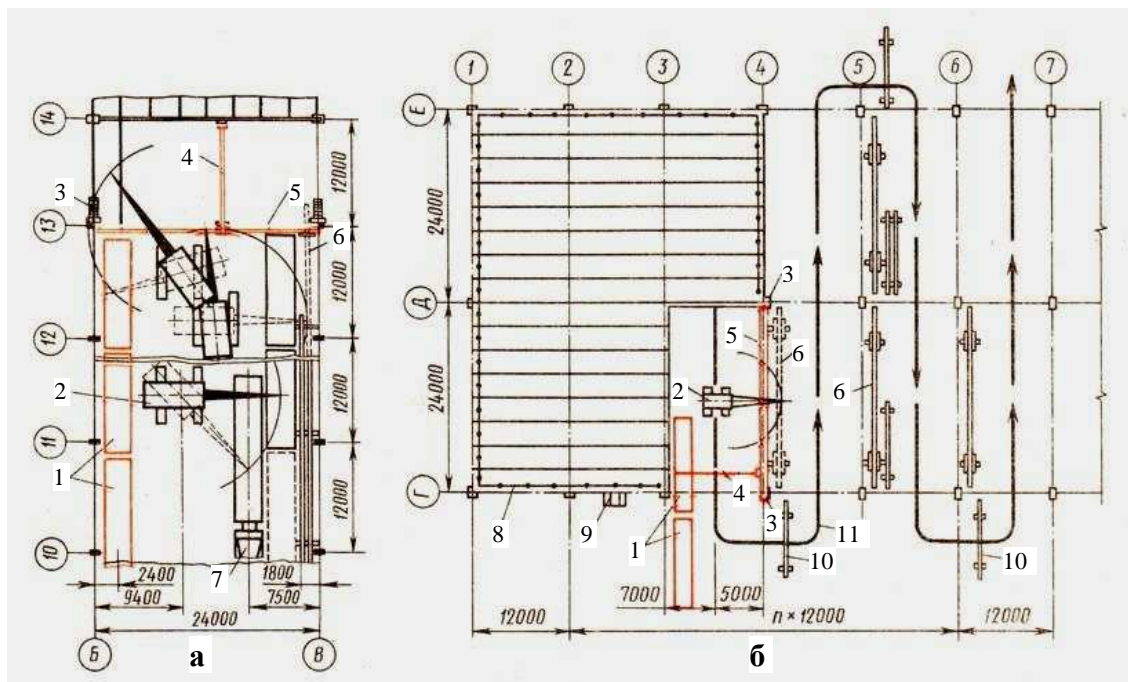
Схема монтажу покриття комплексним методом: а – поздовжнім чином; б – поперечним чином; 1 – плити у стосі; 2 – кран; 3 – приставна драбина з майданчиком; 4 – розпірка; 5 – монтуєма кроквова ферма; 6 – місце укладання кроквової ферми до монтажу; 7 – плитовізі; 8 – тимчасова огорожа на змонтованому покритті; 9 – сходовая драбина; 10 – підкровоква ферма; 11 – шлях пересування крану
